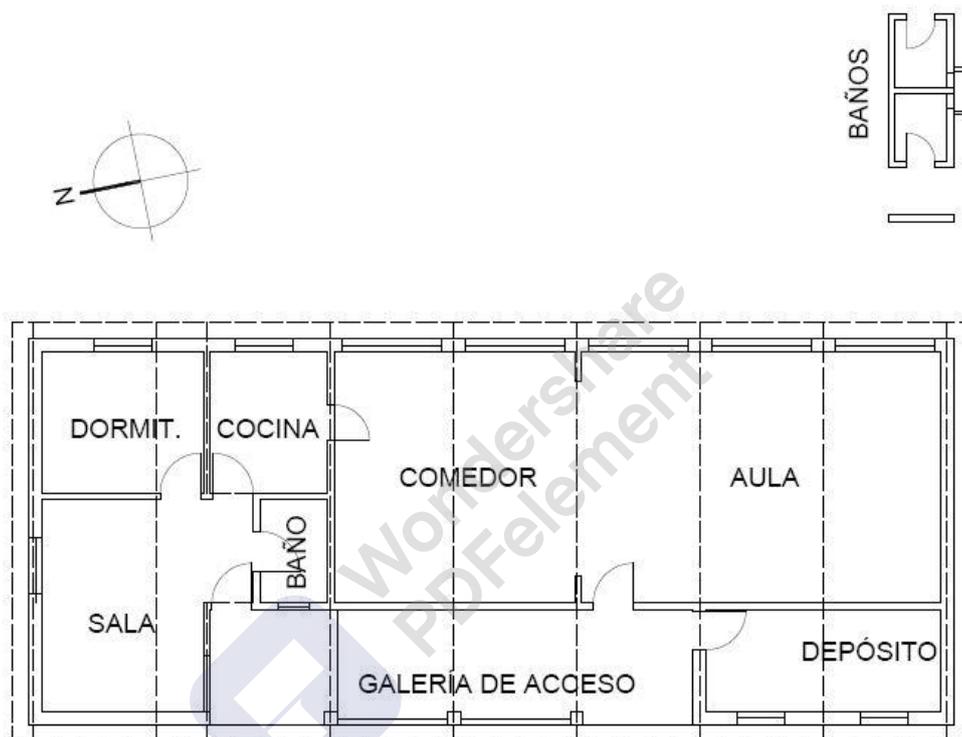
Planta esquemática Escuela rural 68 Zanja Honda de Itapebí.
